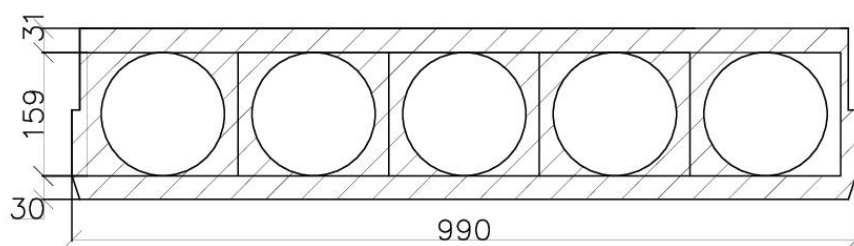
Схема поперечного перетину жб плити перекриття
